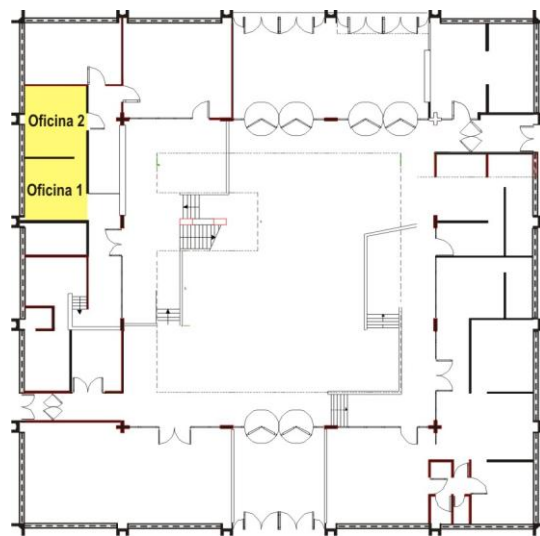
Planta baja del edificio de la FACEyT con las oficinas analizadas.
